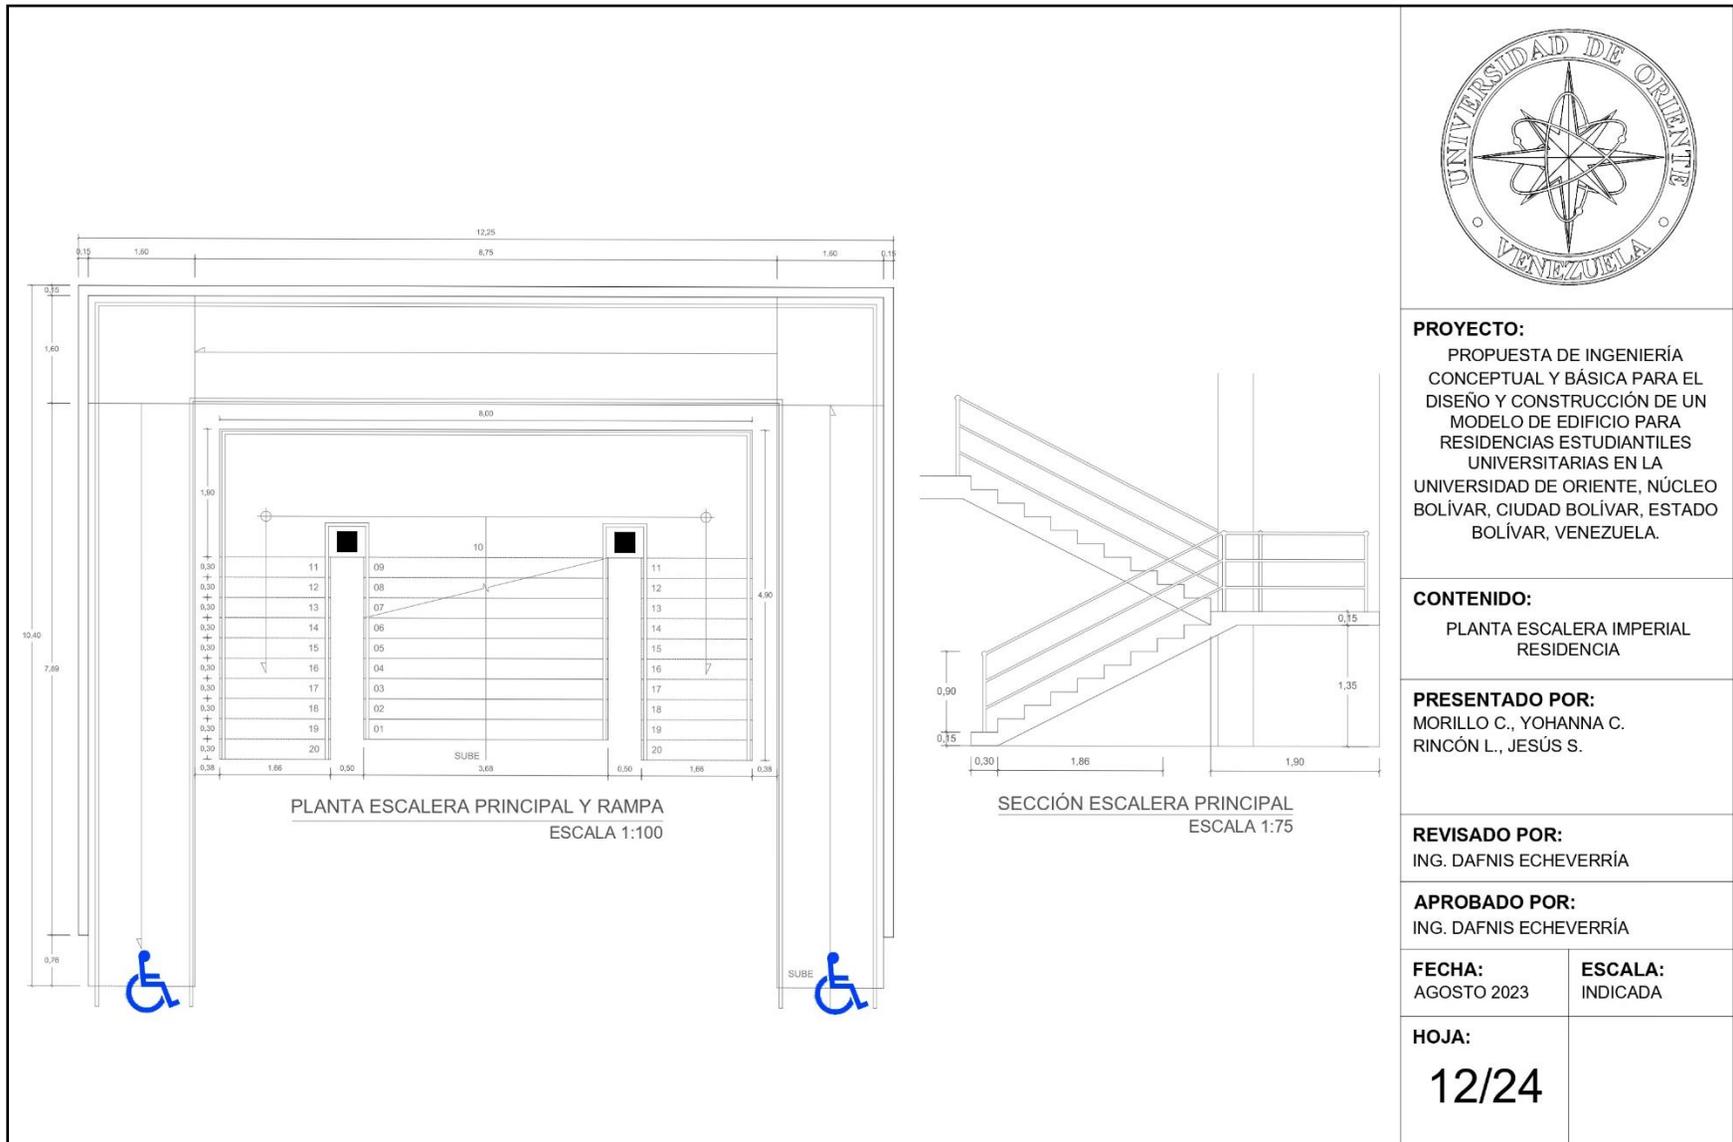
Plano de Planta. Escalera imperial residencia.
